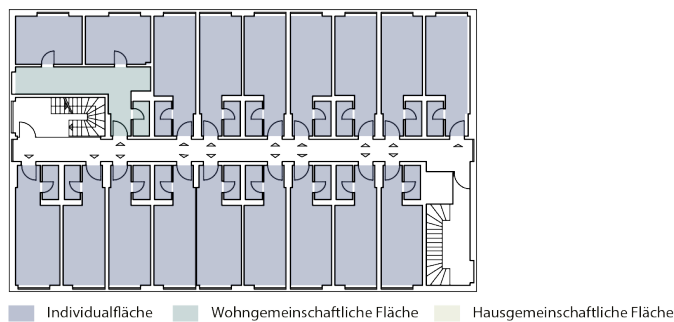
Grundriss Berlin-Grünwald,
